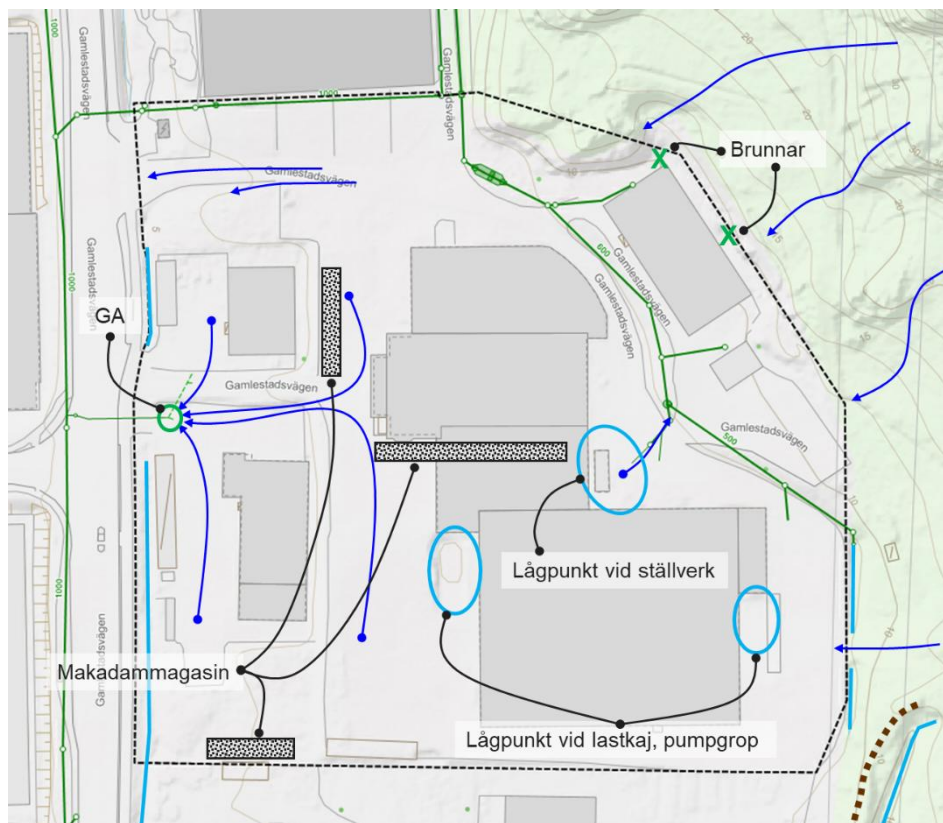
Avledning av dagvatten från planområdet illustreras med lila pilar. Svart streckad linje visar planområdet.
